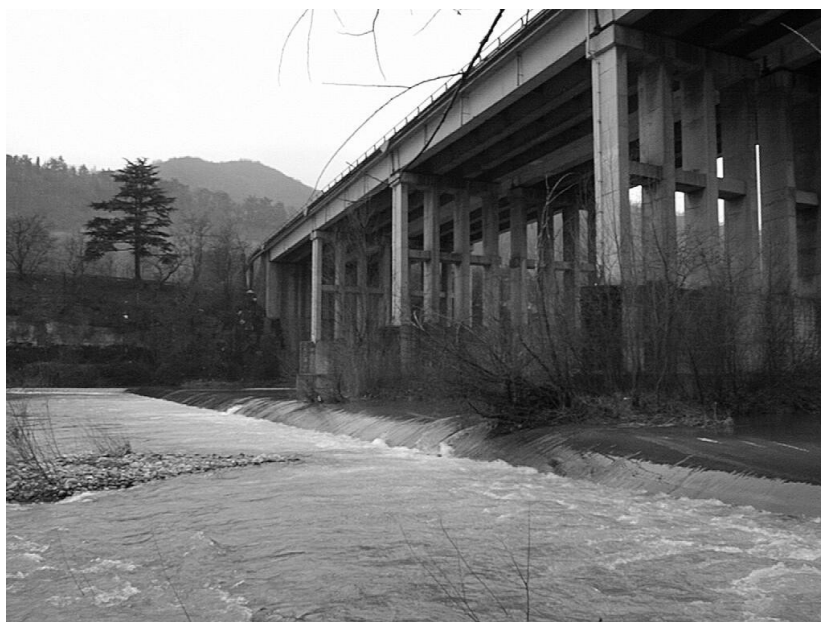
Vista del sito da valle. Si notano l’attraversamento autostradale esistente e, in primo piano, la traversa che ne protegge le fondazioni.
